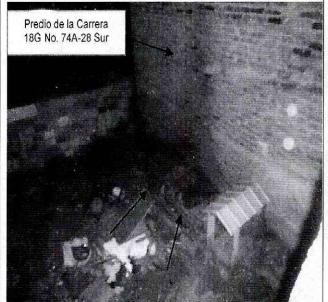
Excavación a manera de pozo de recolección de aguas sub superficiales, sin obras de drenaje.
